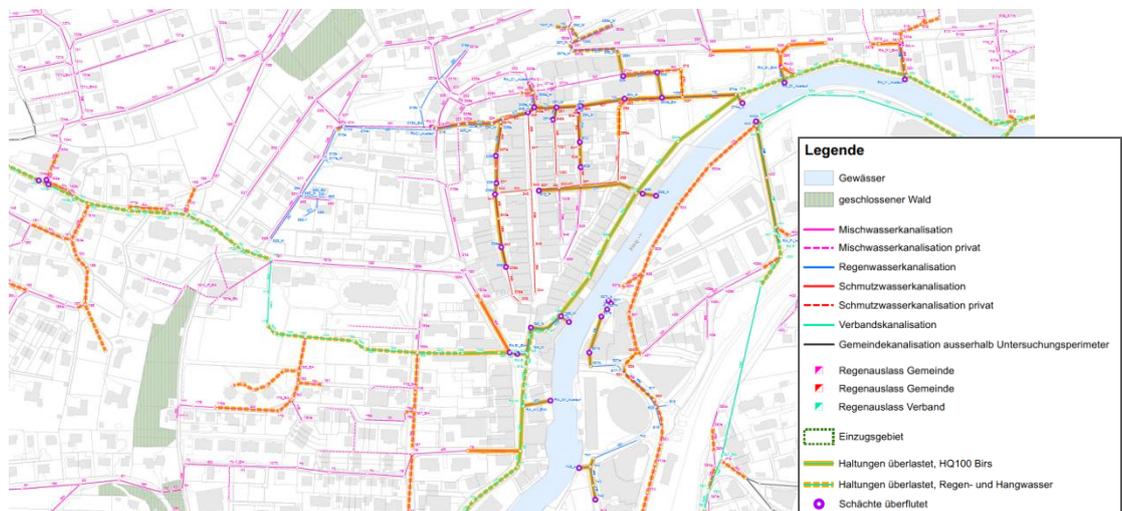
Ausschnitt aus dem Plan L3044/100
